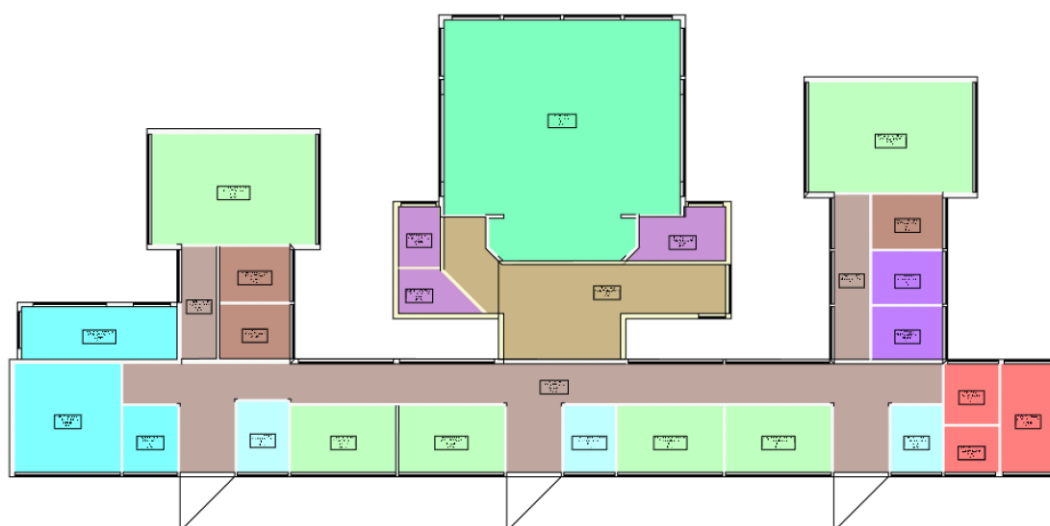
Grundriss EG mit der Zonierung
